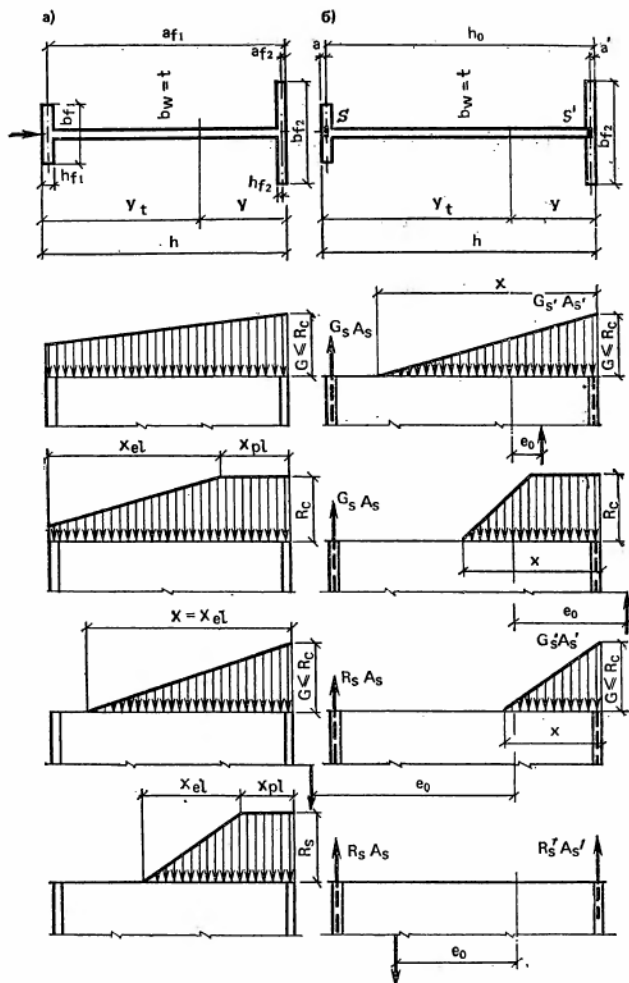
Расчетные эпюры сжимающих напряжений для бетонных (а) и железобетонных (б) горизонтальных сечений столба
